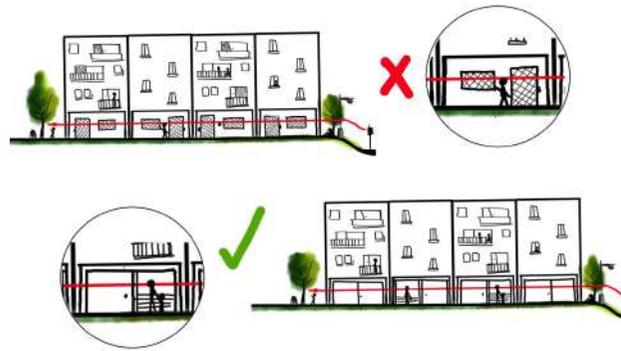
Barreras arquitectónicas en puertas y ventanas
